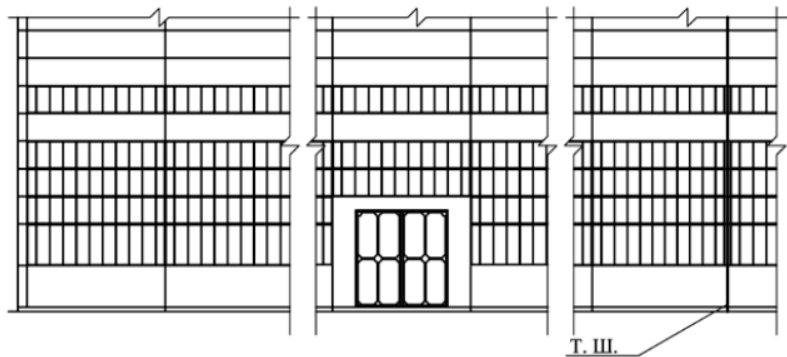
Варіант фасаду торцевої стіни ОВБ
